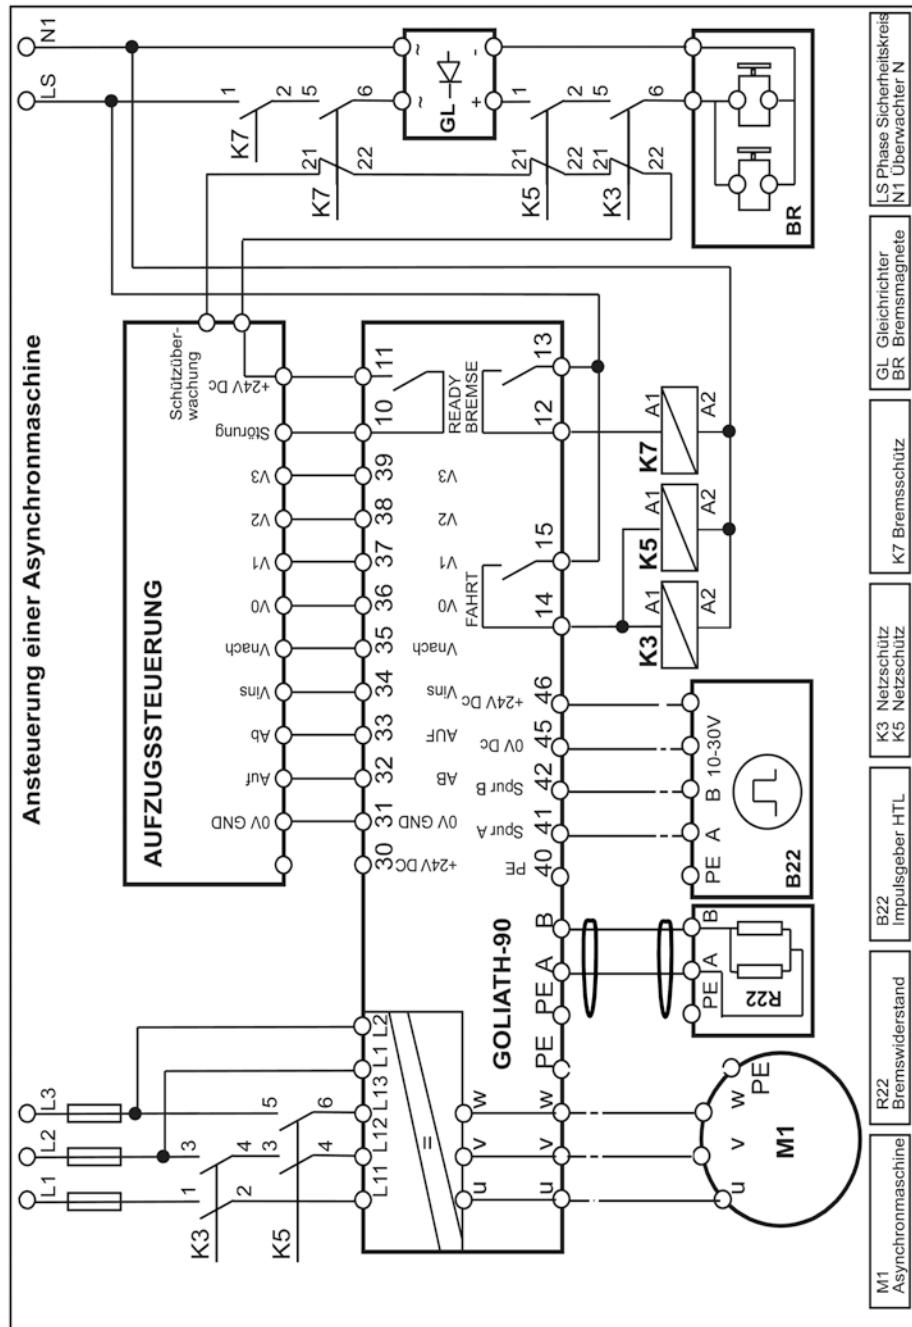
Prinzipdarstellung der Ansteuerung einer Asynchronmaschine (Quelle: KW Aufzugs-technik GmbH, Oberursel)
